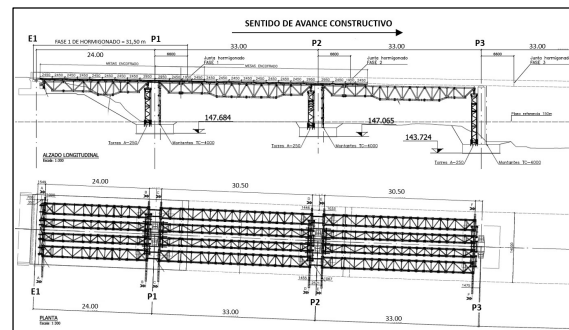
Alzado y planta de las 3 primeras fases de tablero.
